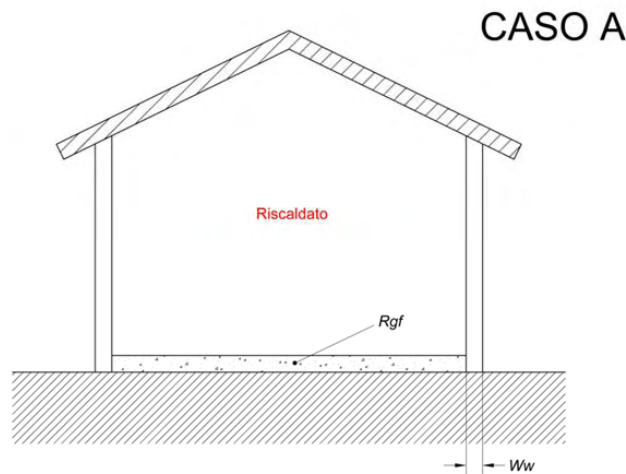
Basamento CASO A –Pavimento su terreno
